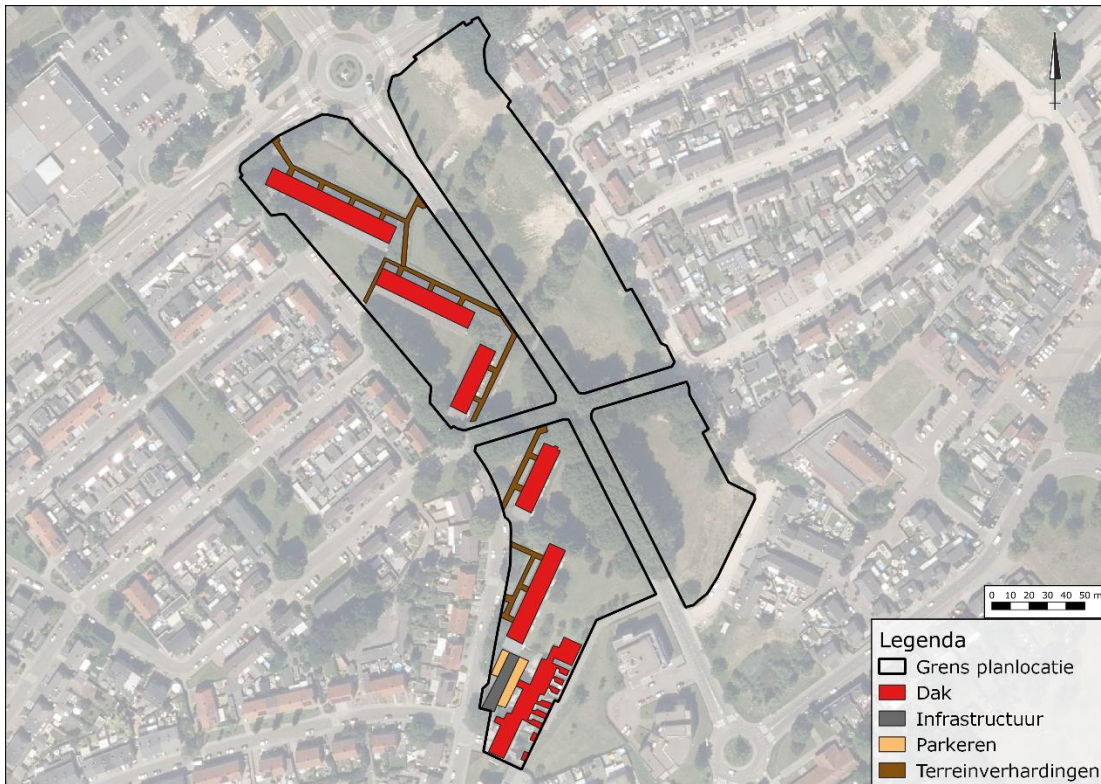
Planvoornemen (bron: Wauben Architecten)
